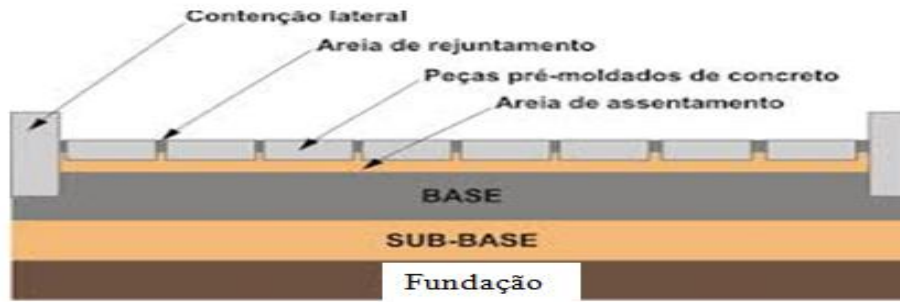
Estrutura de um pavimento em lajetas pré-fabricadas de betão (ABCP, 2009)
